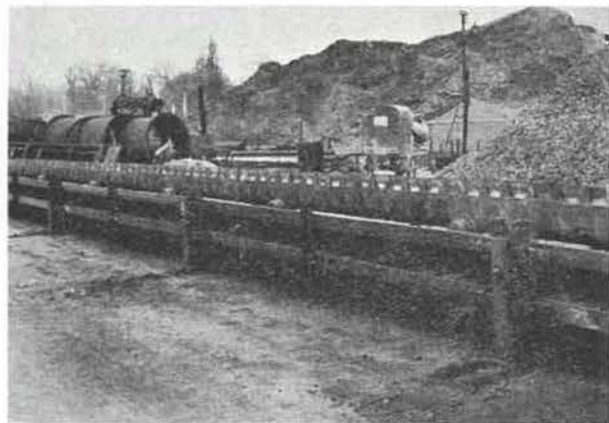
Vue latérale du convoyeur. Vue des supports et longerons.
